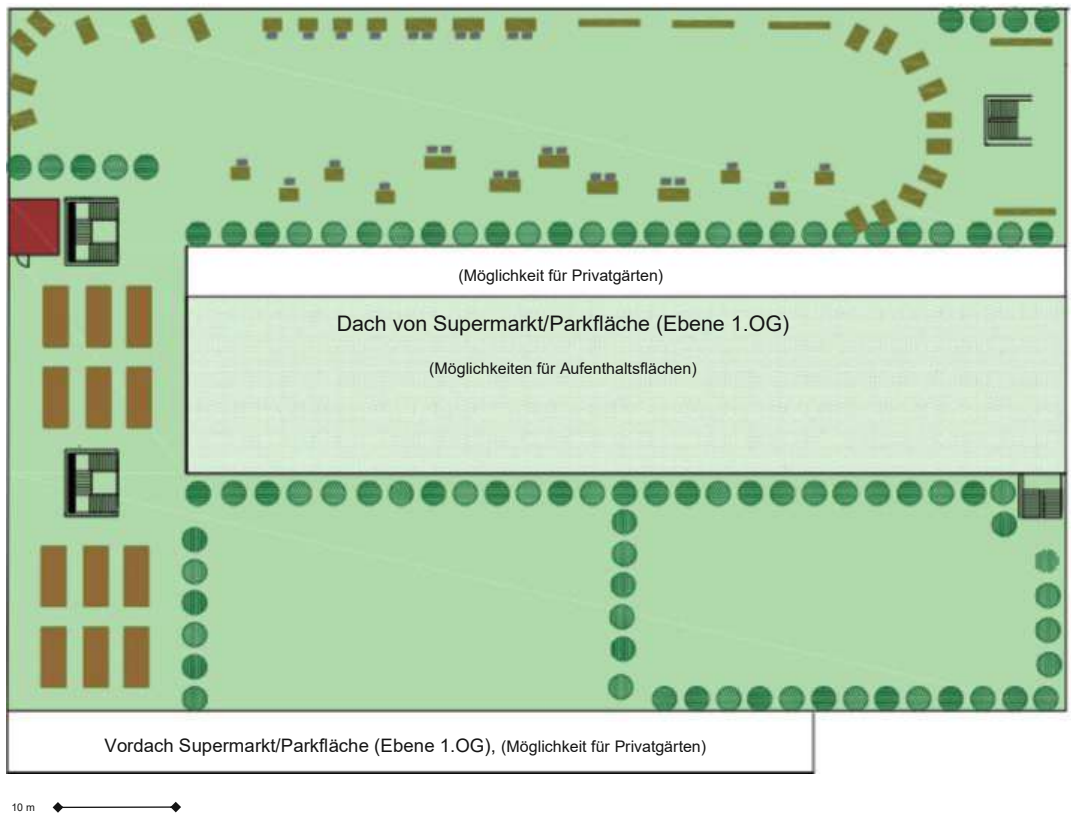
Entwurf Freiraumplan Dach (Quelle: eigene Darstellung)
